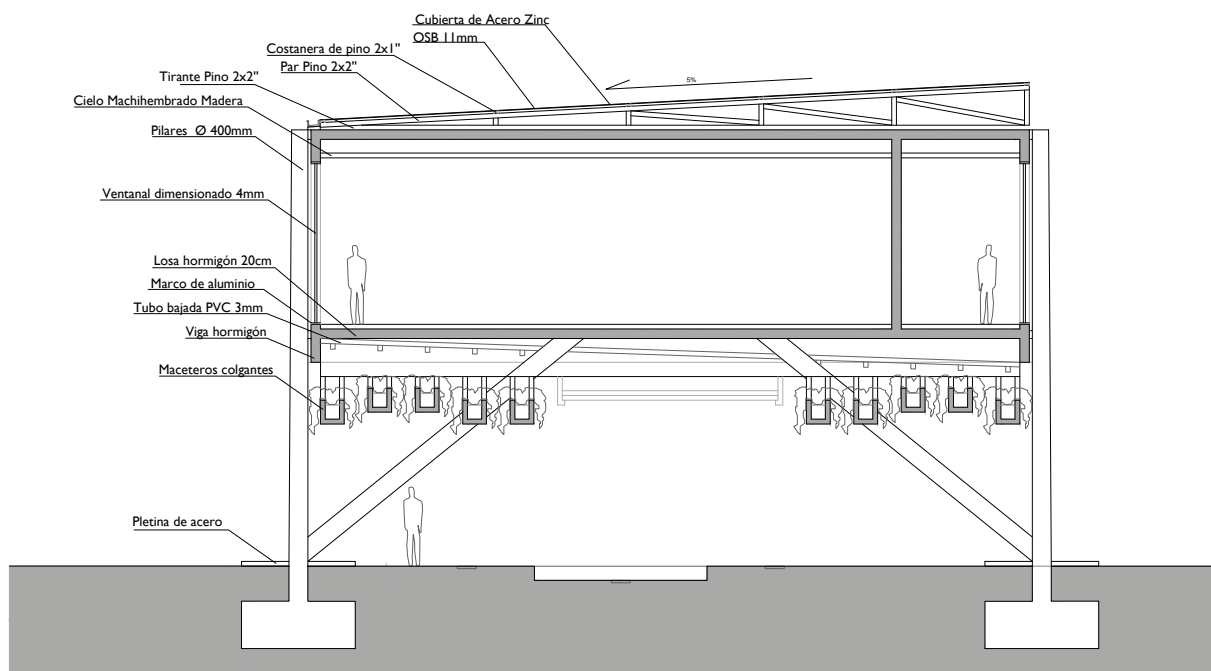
Escantillón con el detalle de los maceteros en la sexta fachada.
